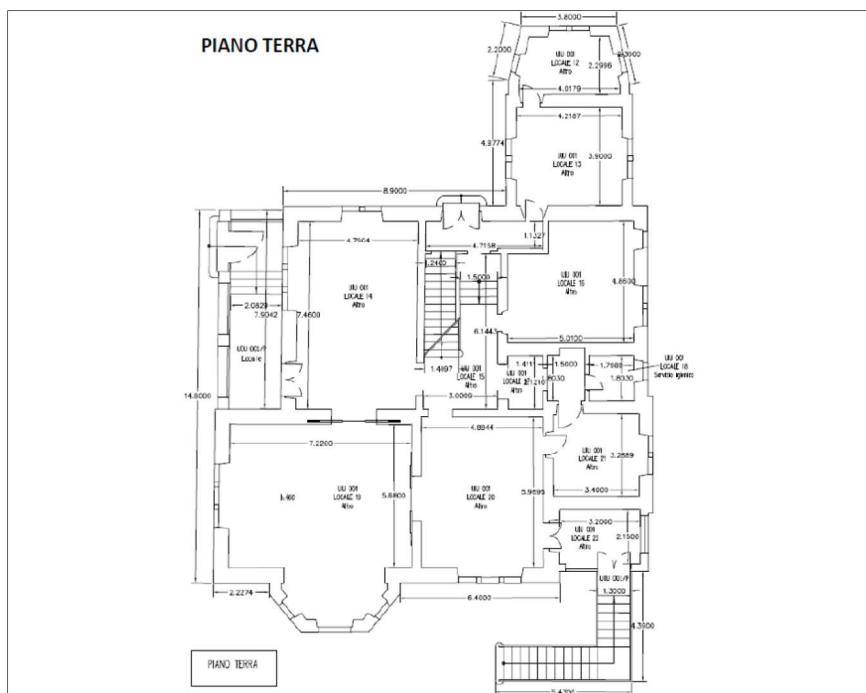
Planimetria Piano Terra - Palazzina Liberty di Villa Gruber
